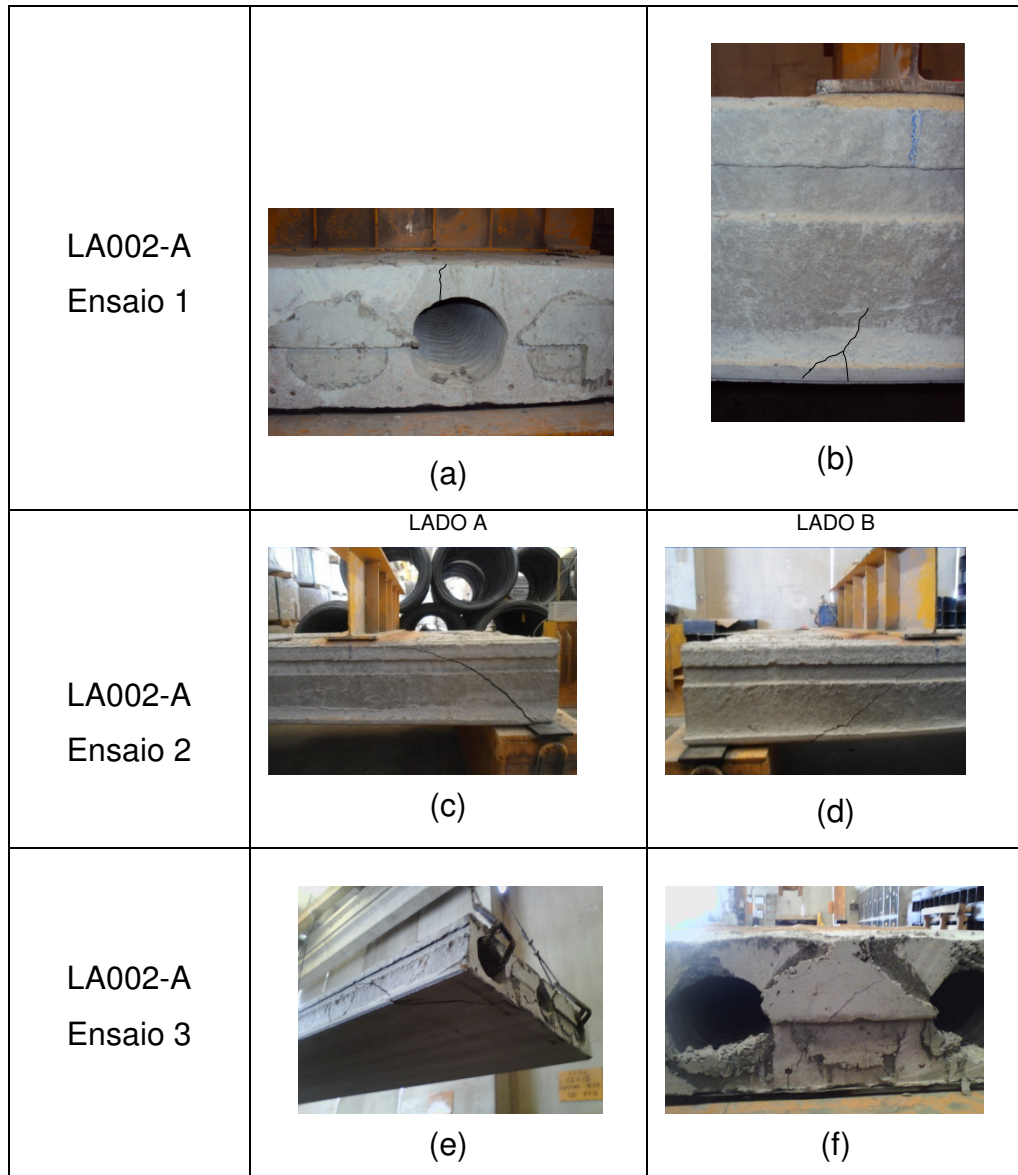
FISSURAS DAS LAJES LA002-A APÓS OS ENSAIOS.
